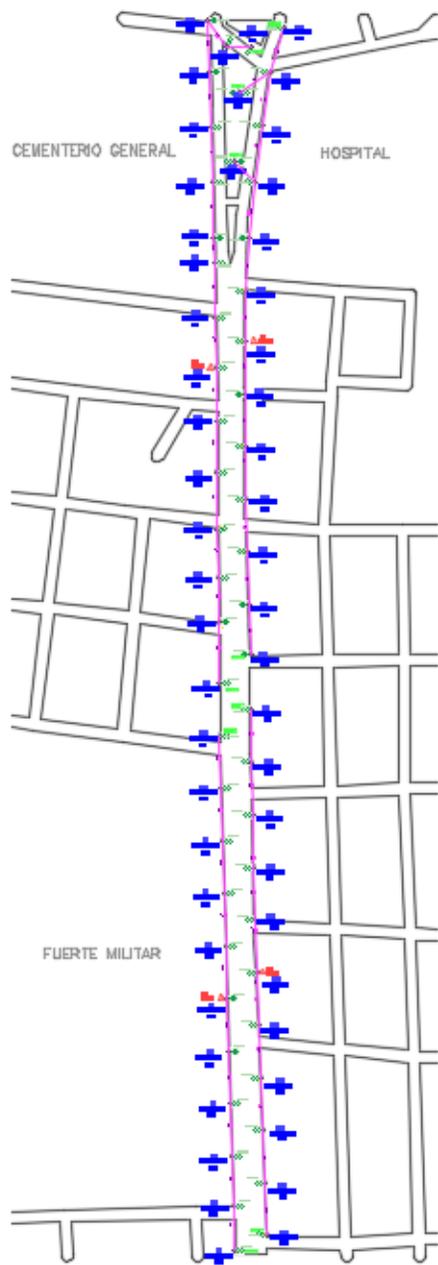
Plano de la propuesta diseñado en AutoCAD.
